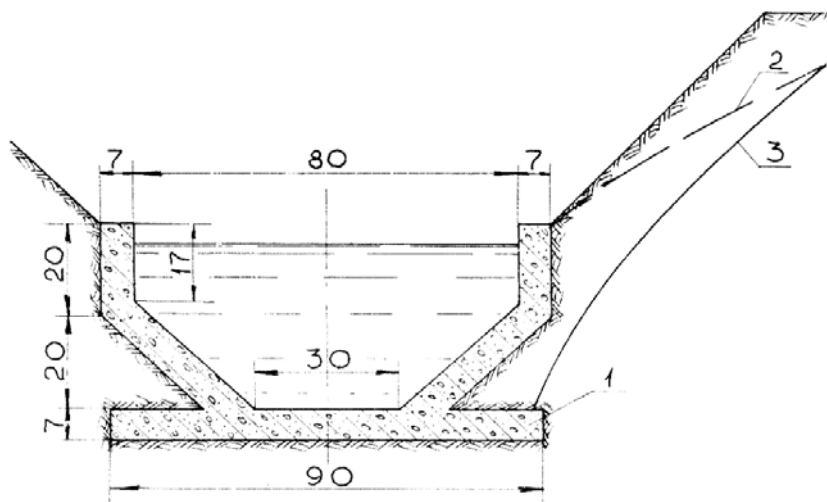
Лотки из пористого бетона с водопроницаемыми открылками:
